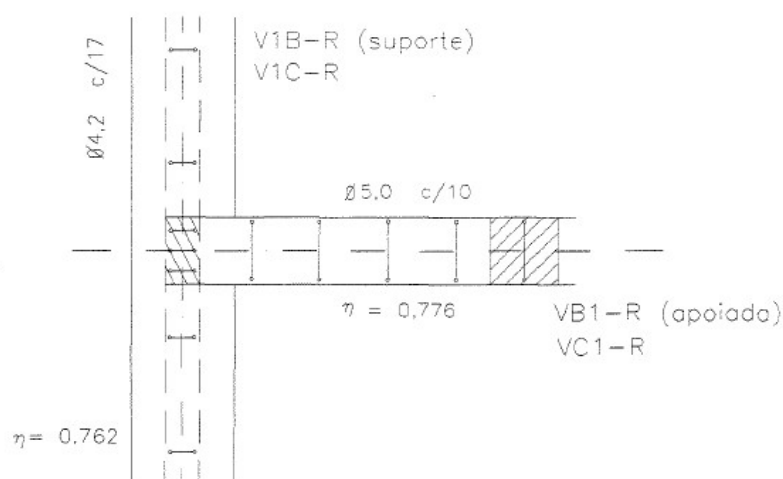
Arranjo da armadura de suspensão do conjunto B1-L
